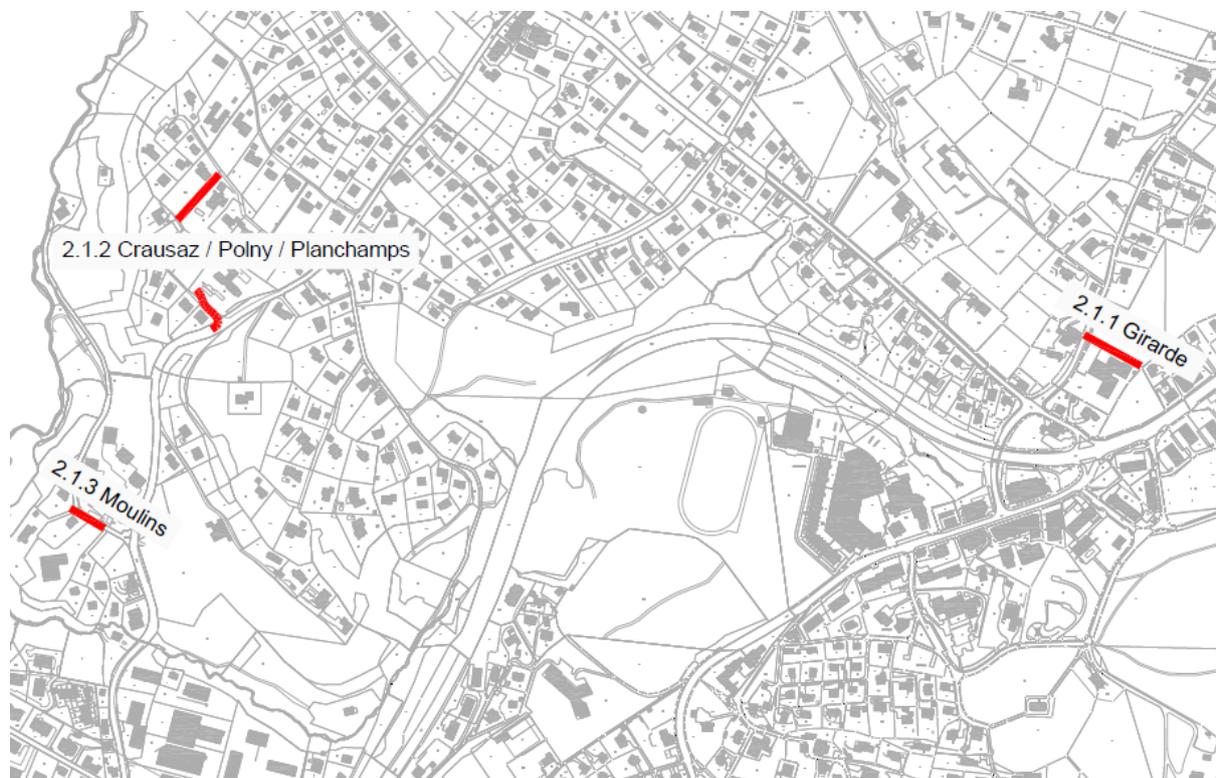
Plan de situation avec les collecteurs faisant l'objet du présent préavis
